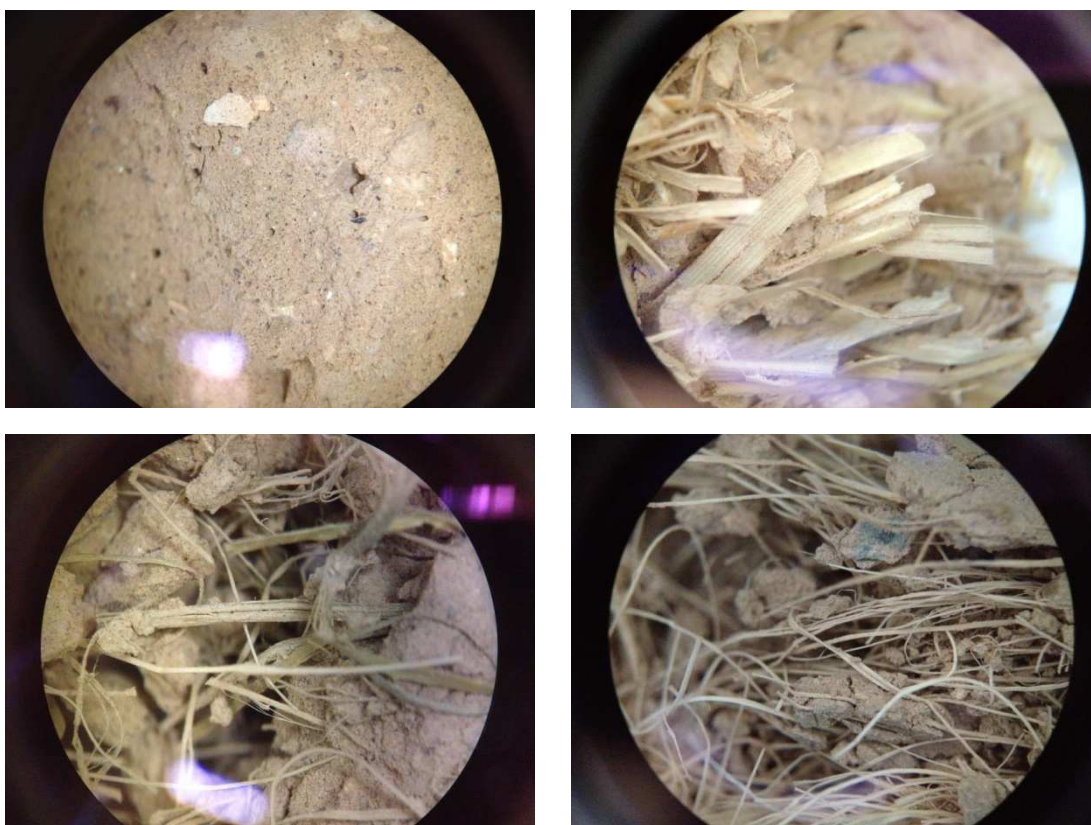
Roturas de las probetas después del ensayo de flexión. Imagen superior izda., barro; imagen superior dcha., barro con paja; imagen inferior izda., barro con esparto; imagen inferior dcha., barro con sisal.
